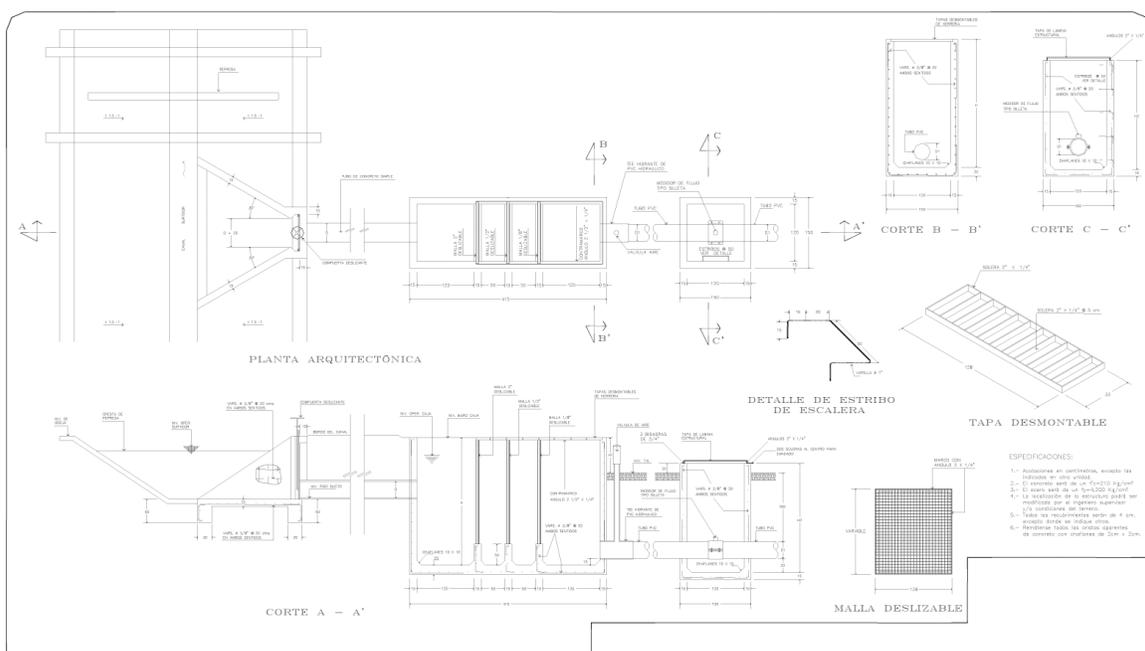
Planta y perfil del canal de aportación y sus estructuras
